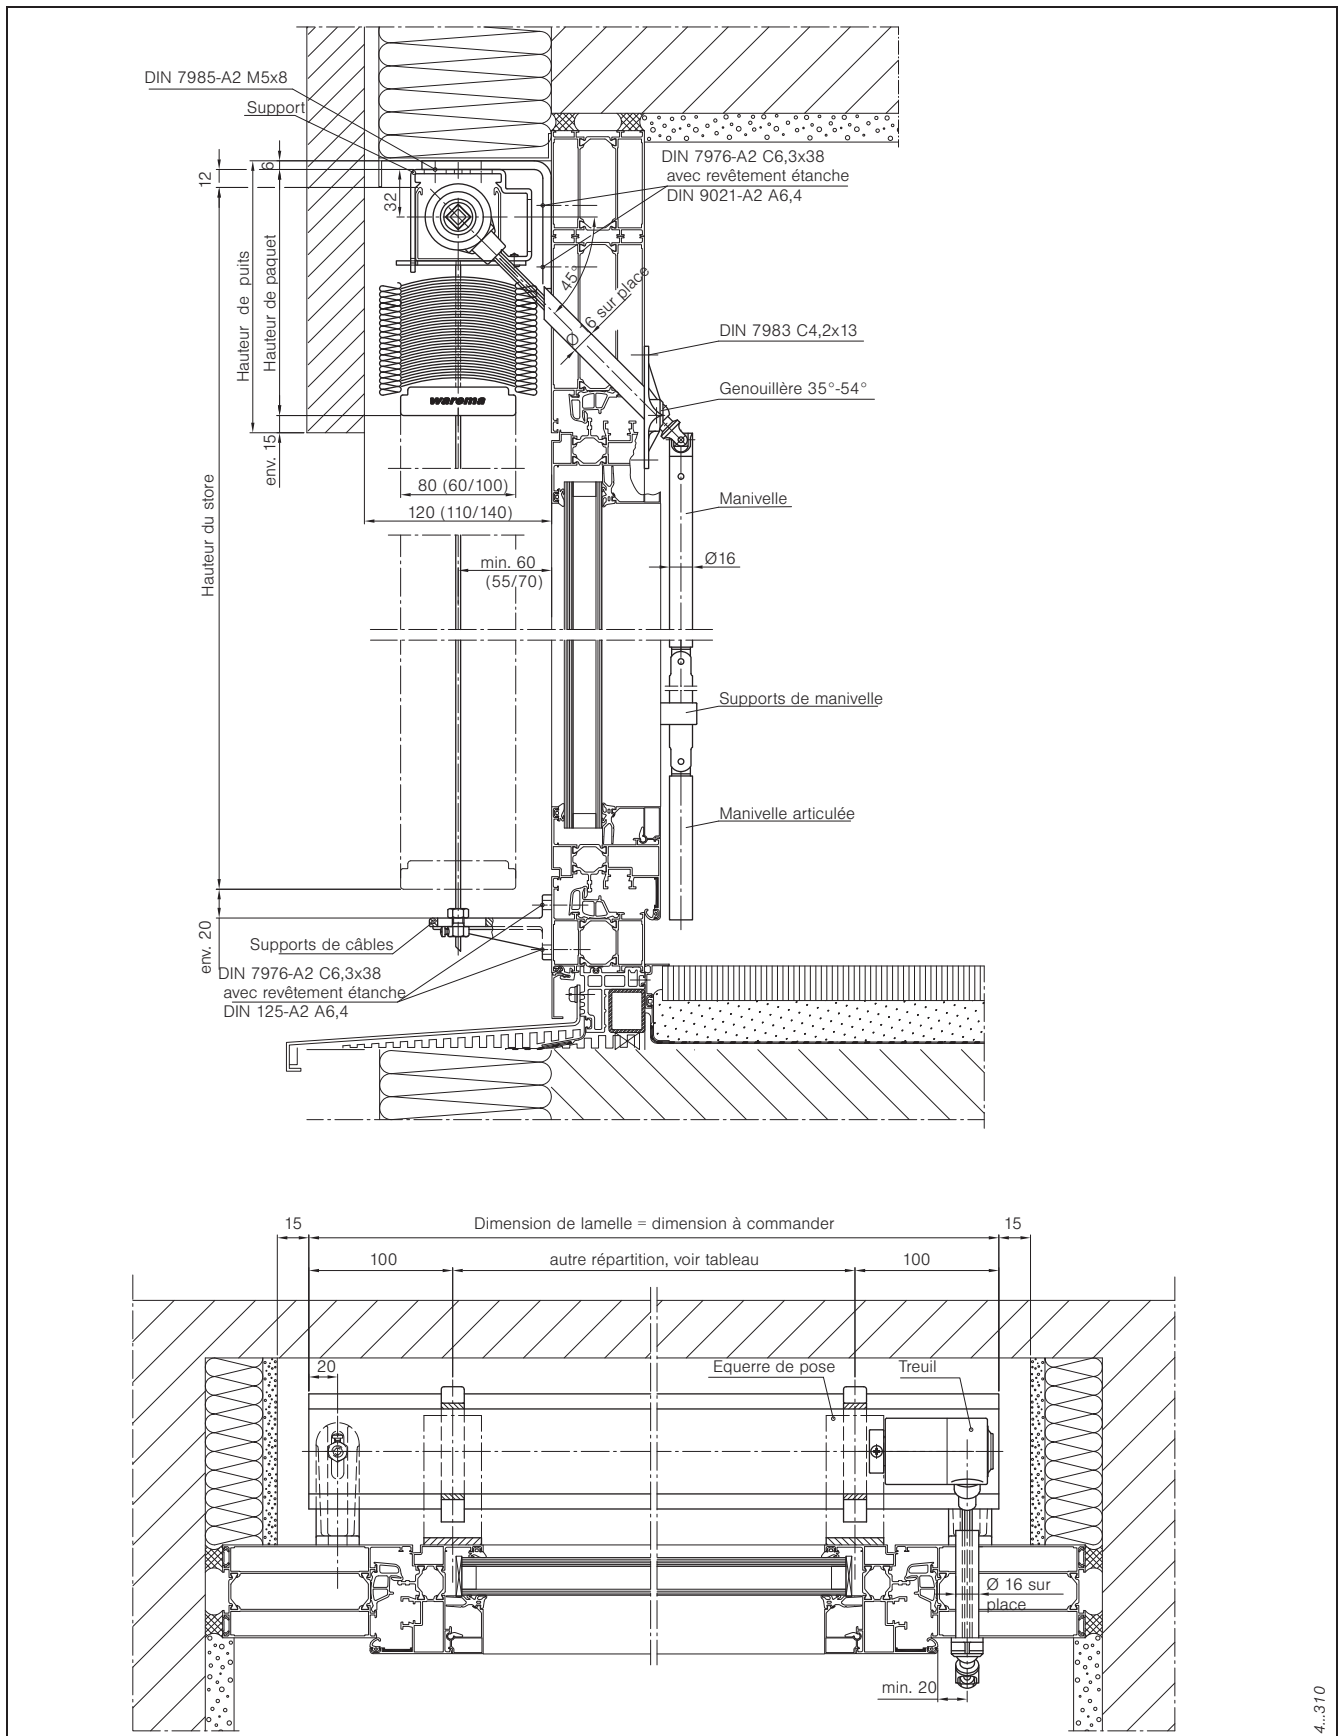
Exemple de pose brise-soleil orientables types C 80/60/100 AF à lamelles plates dans réservation sur place
